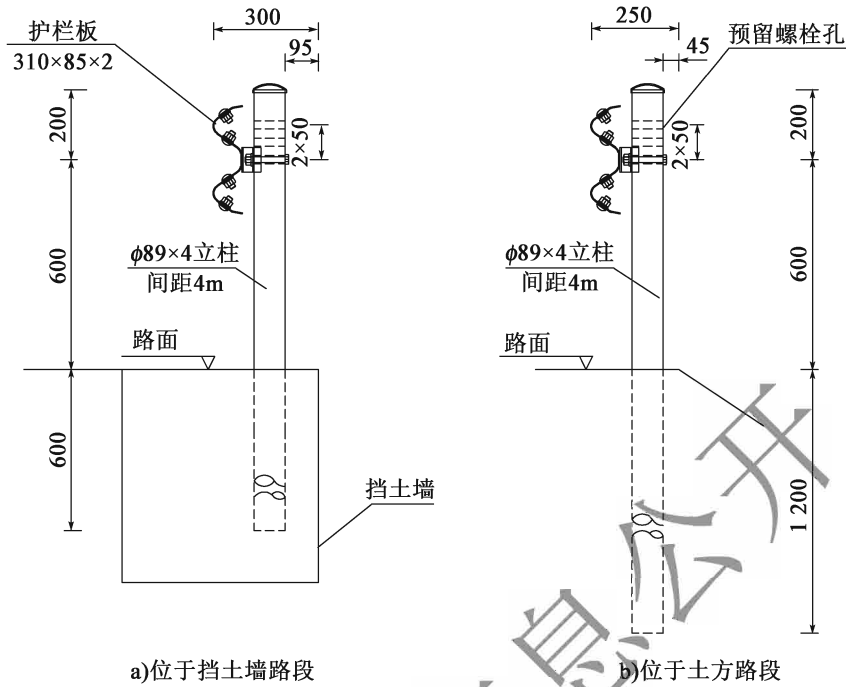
D 级路基波形梁护栏横断面布置(尺寸单位: mm)
